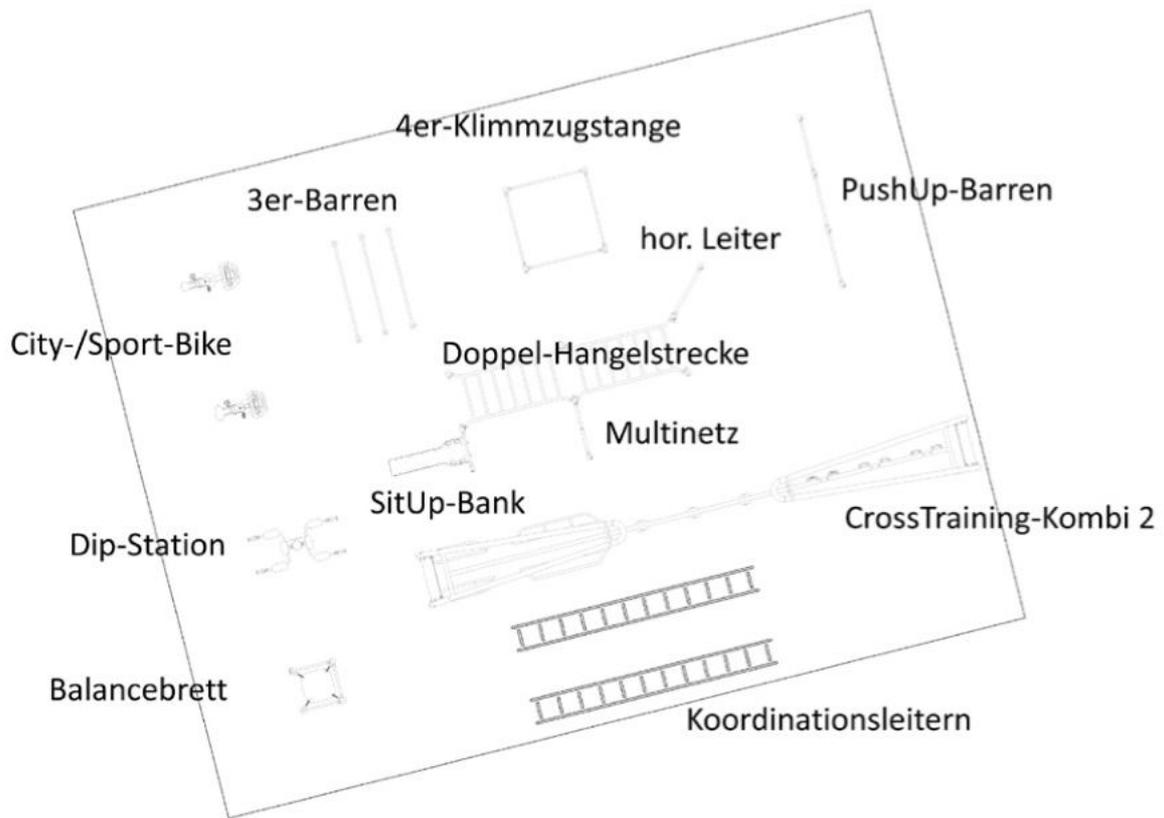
Grundriss geplanter Outdoorfitnessbereich (Fa. Kompan)
